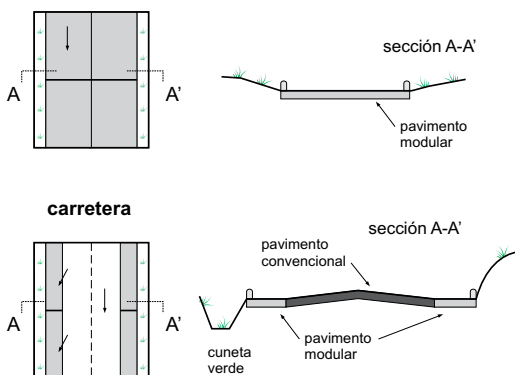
Exemplos de aplicación de pavimentos porosos e modulares en aparcadoiros e estradas (adaptado de ARC, 2001)
